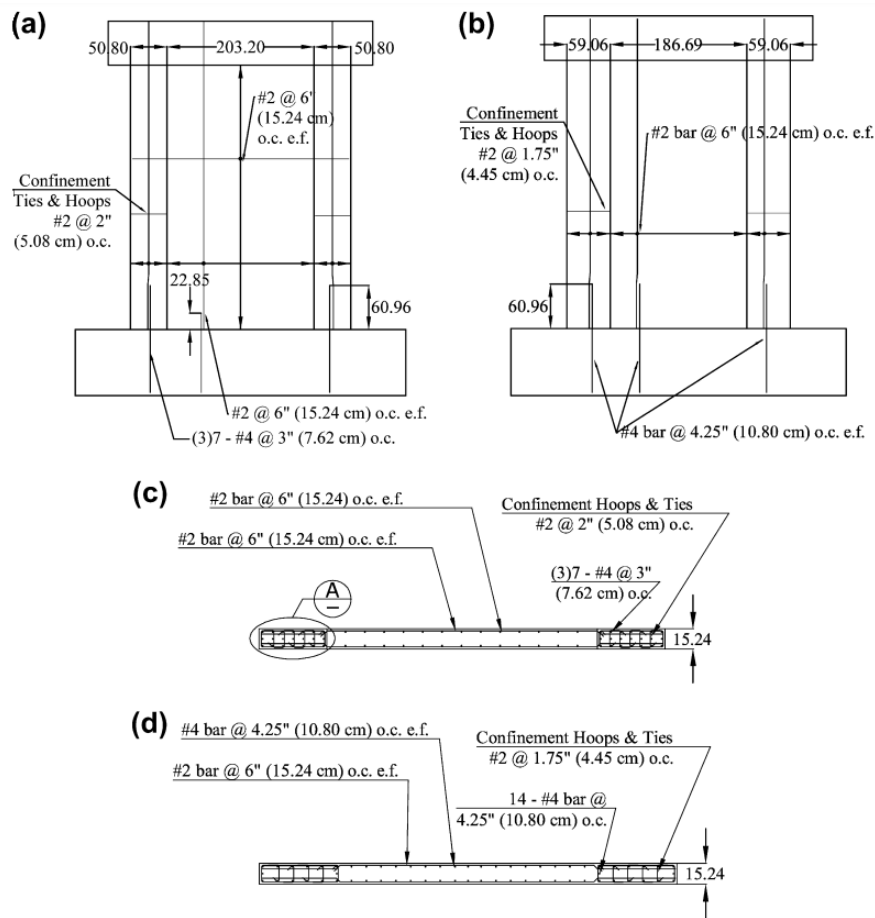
Elevaciones y detalle de las secciones transversales, las unidades están en cm, a menos que se indique lo contrario. Elevación muro PW1, PW2 y PW4, en el muro PW4 no existe el traslape de barras (a); Elevación muro PW3 (b); Sección transversal muro PW1, PW2 y PW4(c); Sección transversal muro PW4 [23].
